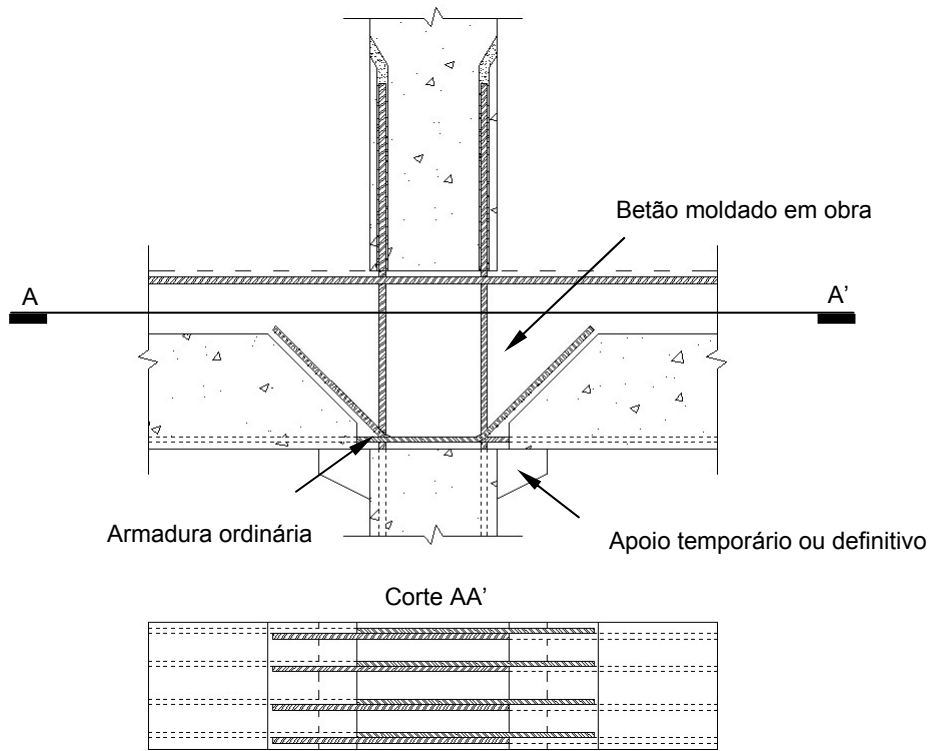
Ligação viga – pilar com amarração das armaduras inferiores da viga no nó
